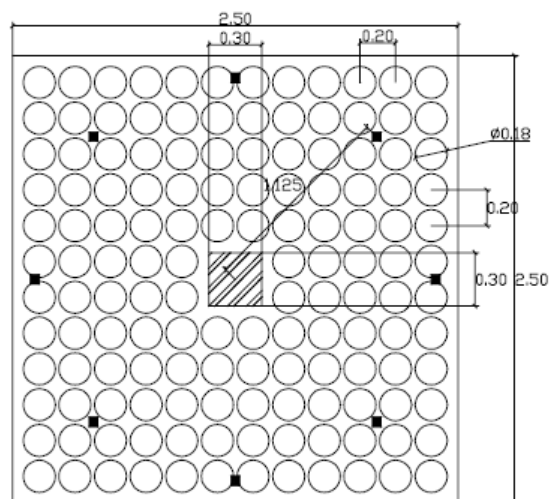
Lajes analisadas com 23 cm de espessura, vista em planta, [HELD (2002)]
